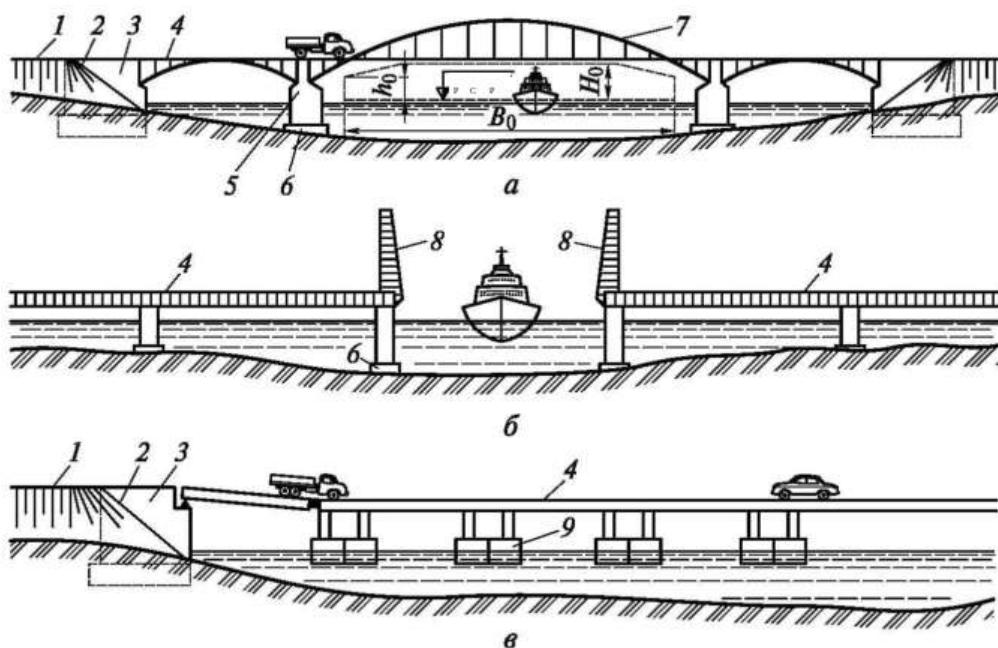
Види мостів за типом опор і прогонової будов (1 – земляний насип підходу; 2 – конус насипу, який часто укріплений бетонними накладними плитами чи габіонами; 3 – берегова мостова опора; 4 – прогонова будова (аркова) з їздою згори; 5 – проміжна опора; 6 – фундаменти проміжних мостових опор; 7 – прогонова будова (вантово-аркова) з їздою автомобілів посередині; 8 – розвідна прогонова будова; 9 – плавуча (понтонна) опора наплавного мосту) [7]
